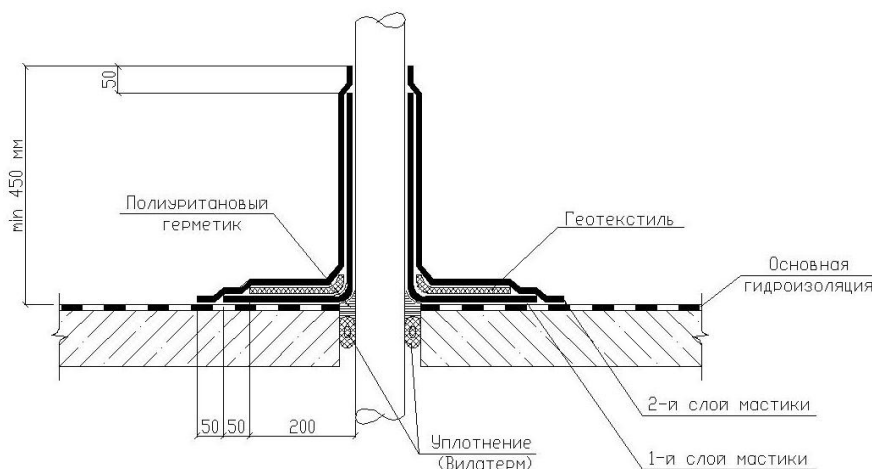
Устройство гидроизоляции примыкания кровельного покрытия к холодным трубам из материалов, обладающих адгезией к полиуретановым мастикам.
